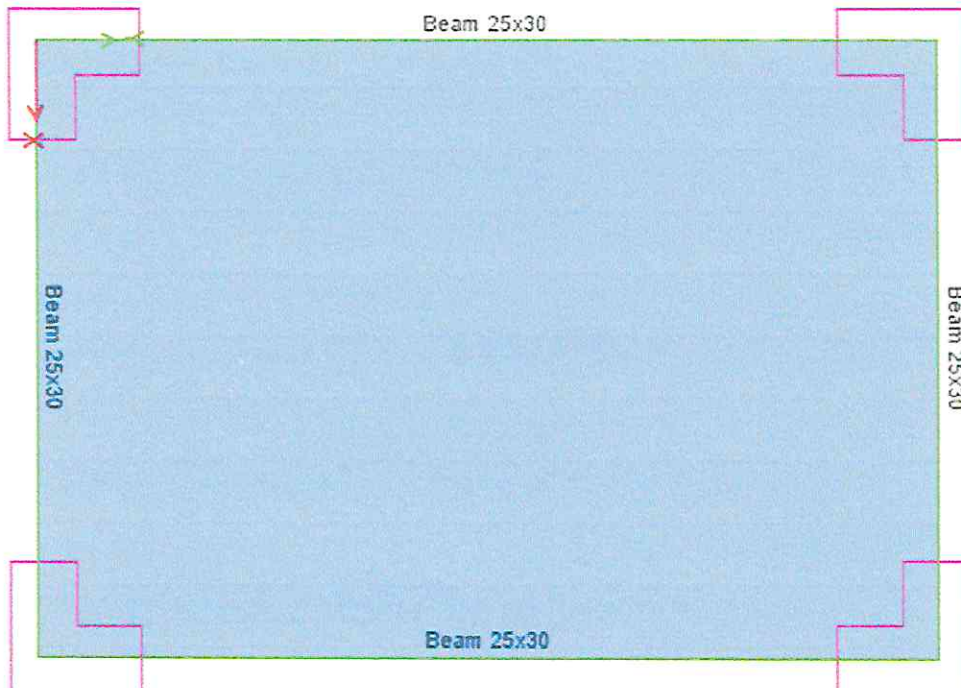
Planta 2do y 3er piso - Tanque Cisterna – Elevado, modelado en ETABS
